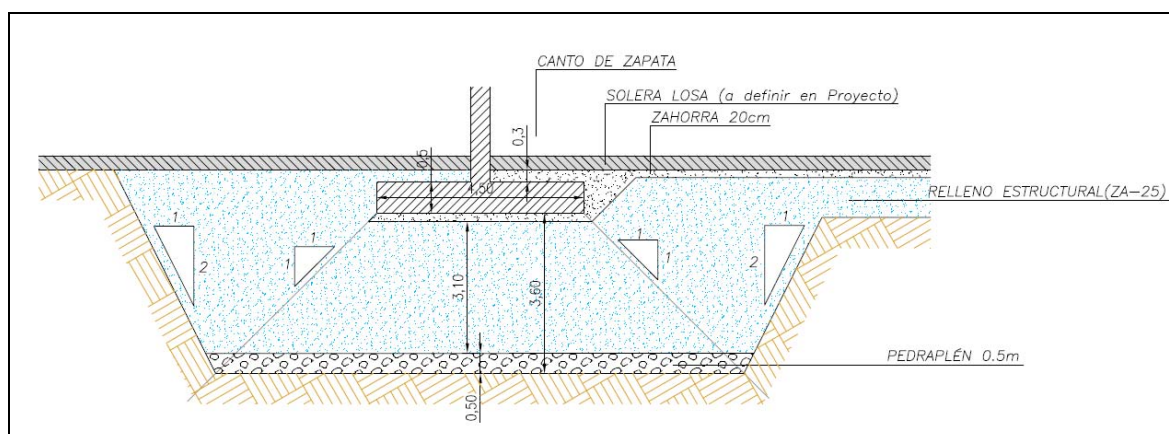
Croquis ejecución de relleno estructural bajo cimentación
